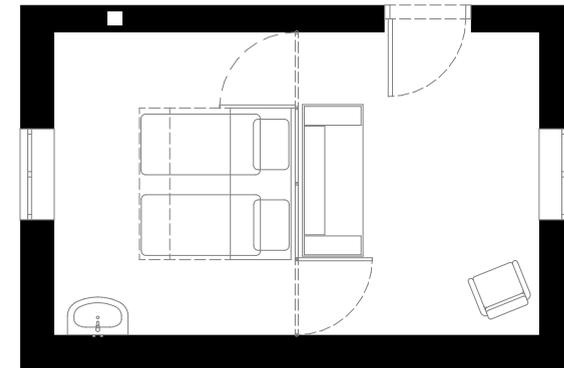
Grundrissvariationen Obergeschoss 1:100
